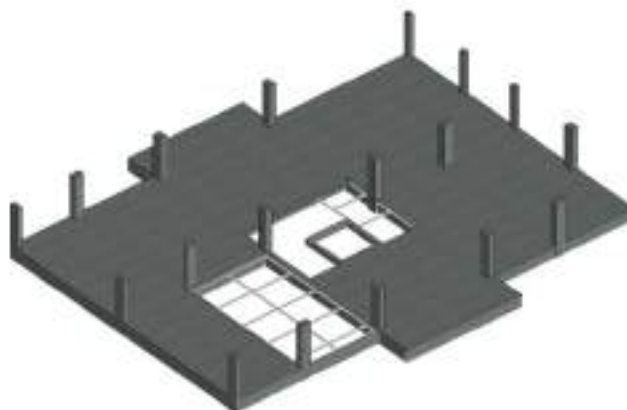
Perfis Suporte Paineis Wall – 02 Pavimento
